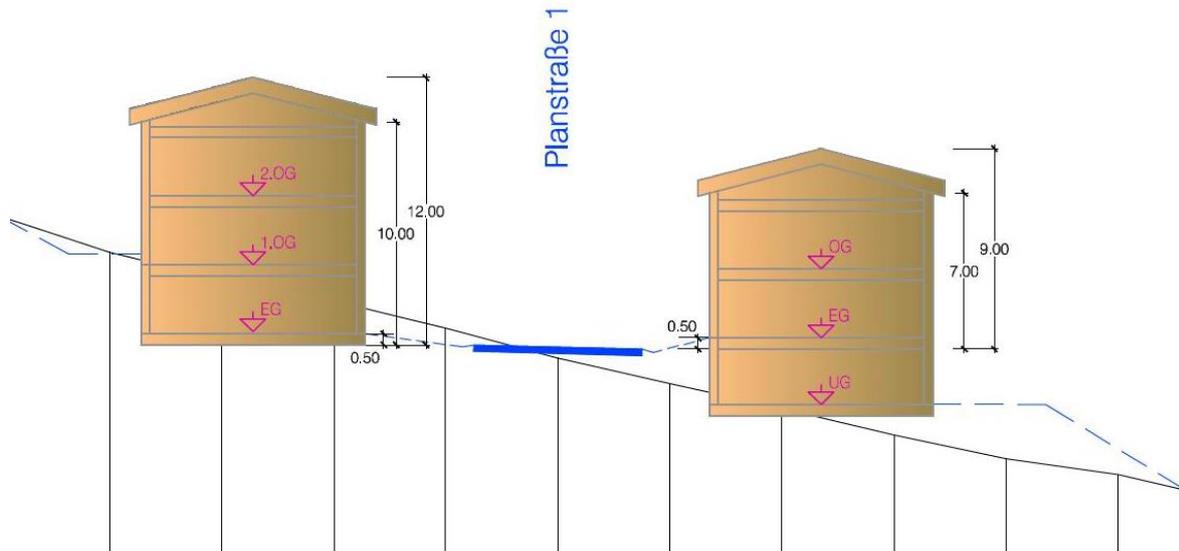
Geländeschnitt mit Darstellung der Bezugspunkte und zulässiger Höhe baulicher Anlagen
